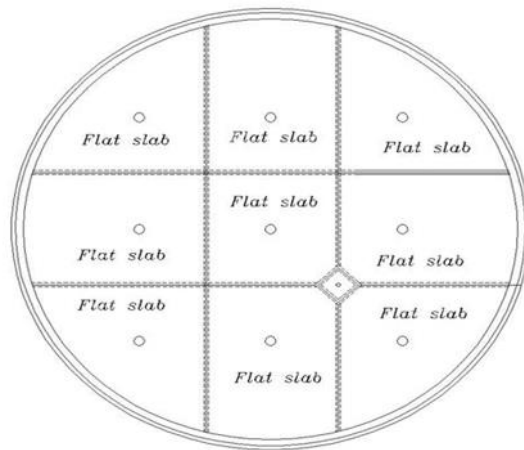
المسقط الأفقي للطابق الثاني للمبنى الرياضي.
